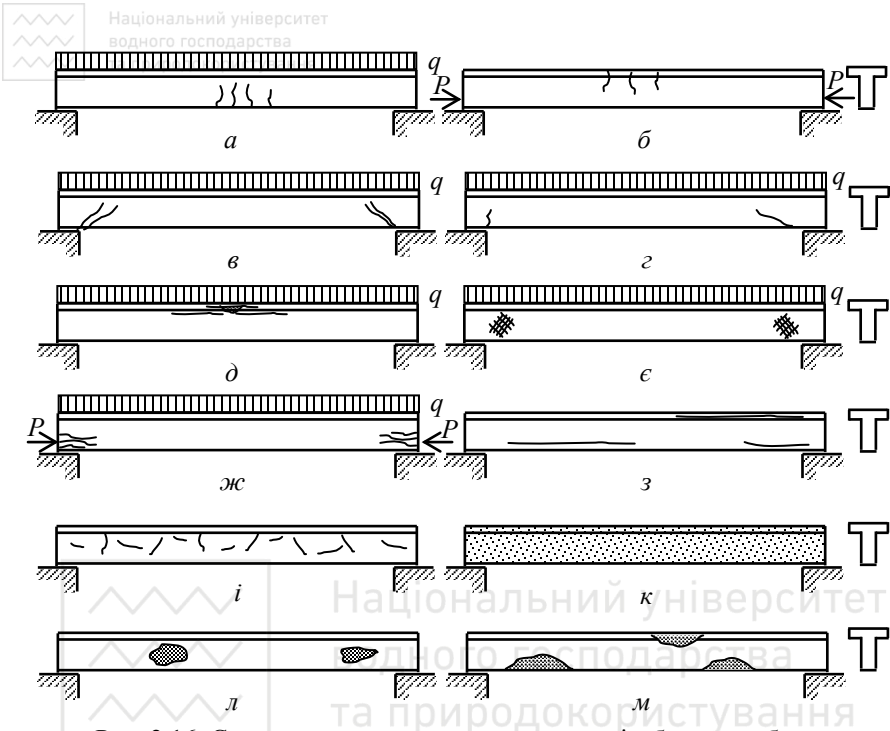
Схеми можливих пошкоджень в залізобетонних балках:
